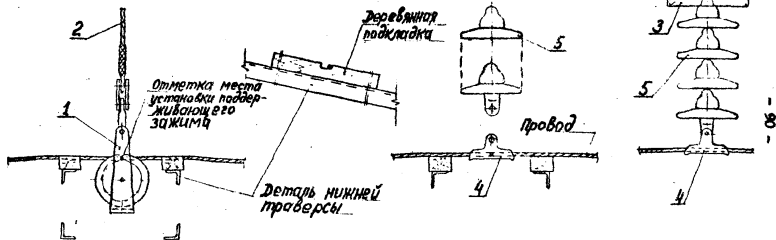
Узел А. Перекладка провода верхней траверсы с опусканием на нижнюю траверсу опоры
